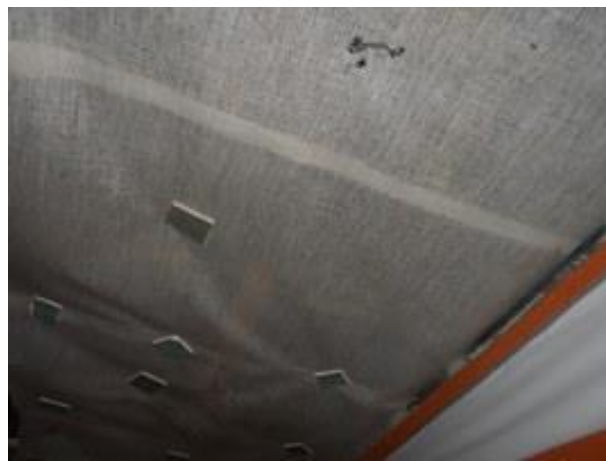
Часть помещения №2,3 помещения 6-Н, потолок
